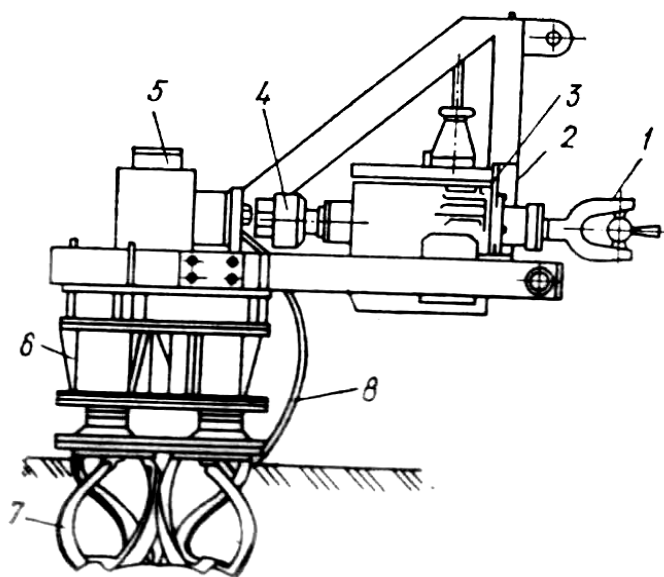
Фрезерна машина з вертикальною віссю обертання та спіральними ножами
